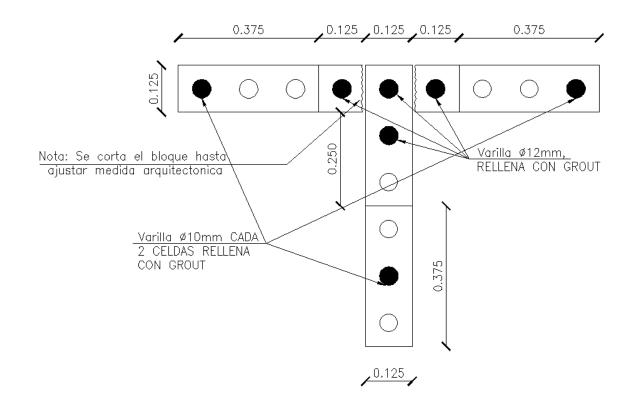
Vista en planta esquina en "T" segunda hilada
